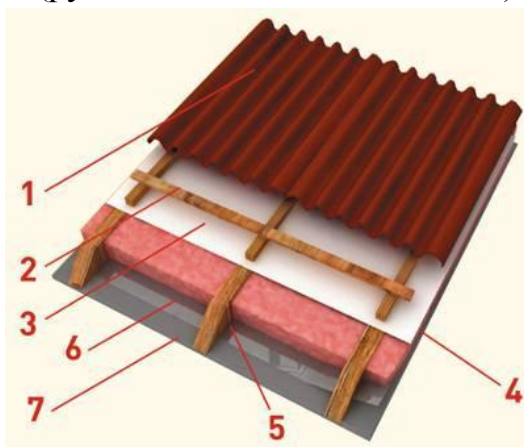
Структура скатной кровли: 1 – черепица или другой кровельный материал; 2 – шаговая (поперечная) обрешетка; 3 – ветро- и влагозащитная мембрана; 4 – слой утеплителя; 5 – стропила; 6 – слой пароизоляции; 7 – слой внутренней отделки
